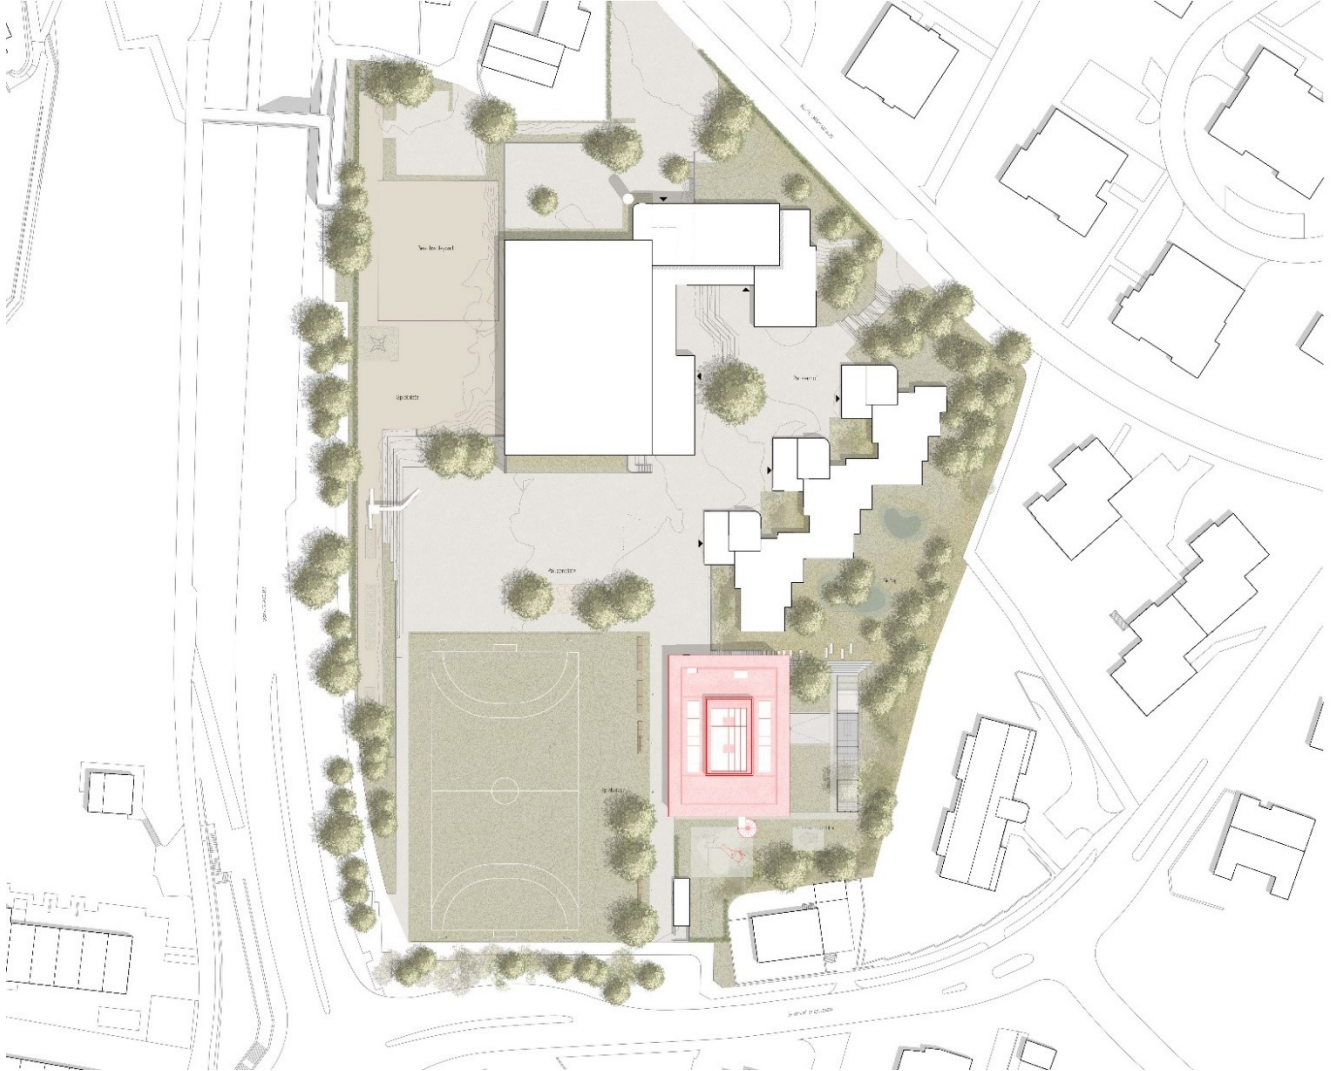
; Situationsplan, der zeigt, wo sich der bereits erstellte Erweiterungsbau befindet, der nun aufgestockt werden soll.
